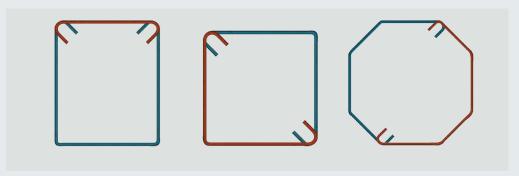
Estribos de dos piezas aceptables para encamisado de concreto. Fuente: elaboración propia.
